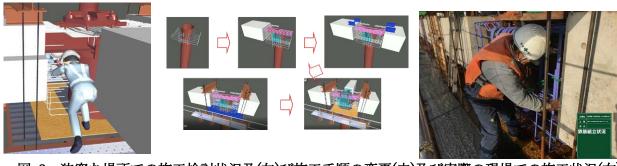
狭窄な場所での施工検討状況及(左)び施工手順の変更(中)及び実際の現場での施工状況(右)
